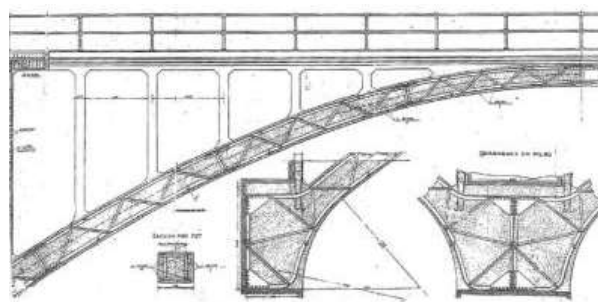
Autocimbra existente en los arcos del Puente Galcerán. (Figura extraída del proyecto de construcción original)
